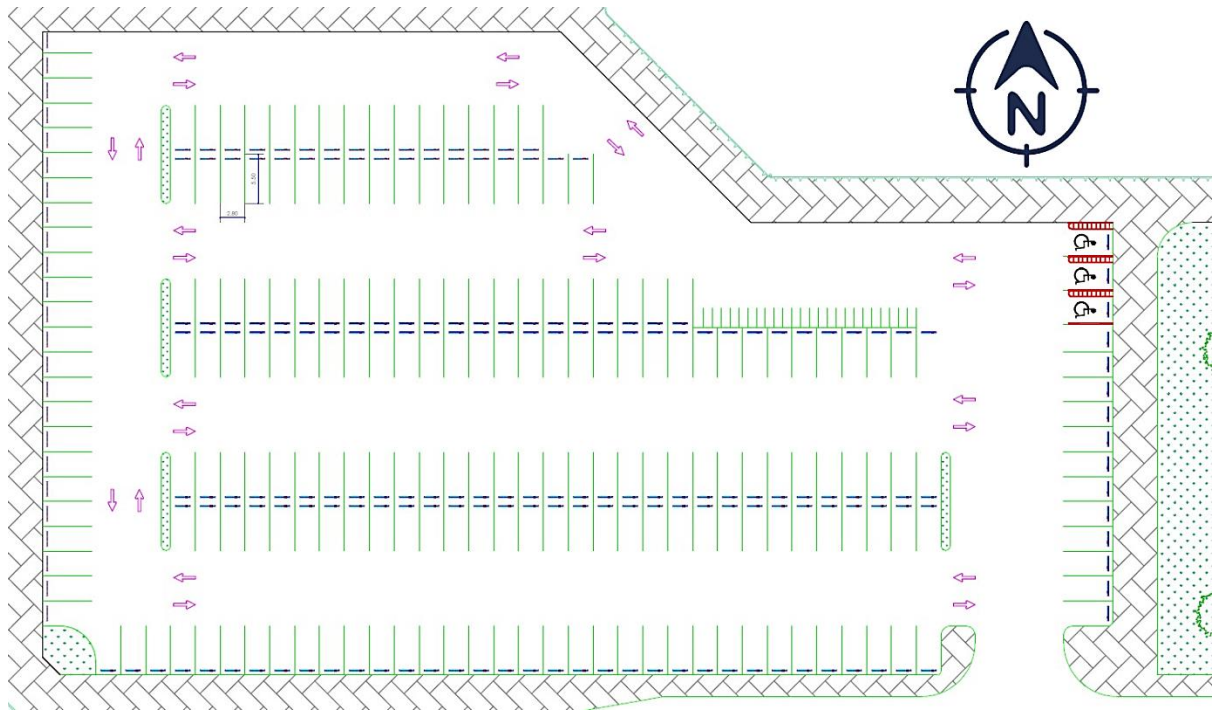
Vista en planta del estacionamiento para público. Fuente: elaboración propia.
